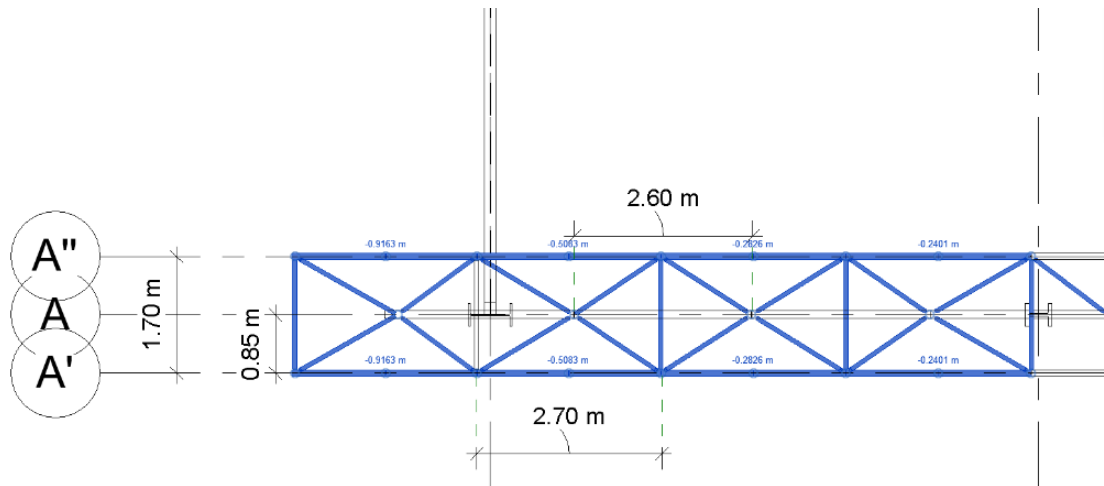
Modelado de triditrabe vista en planta (elaboración propia).
